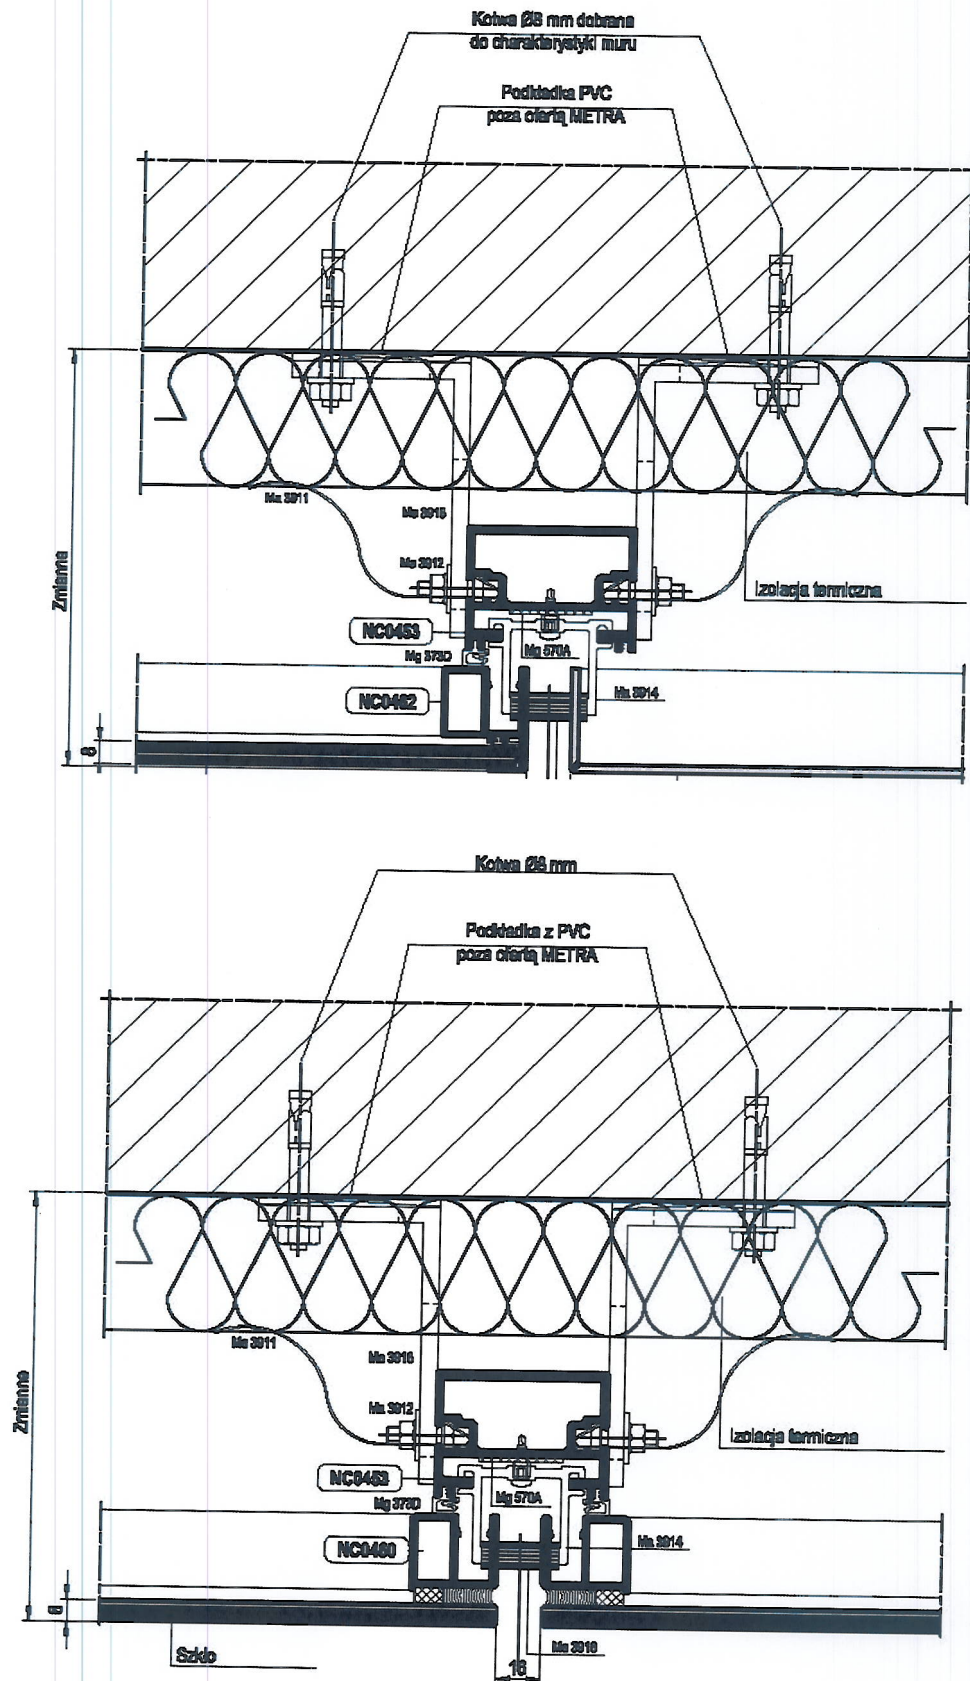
Szczegóły montażu elementów pionowych i wsporników podkonstrukcji
